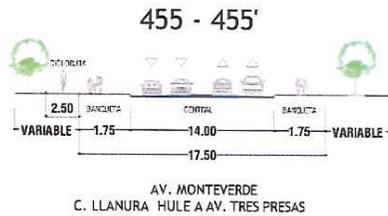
Sección vial propuesta Av. Monteverde.<sup>128</sup>
